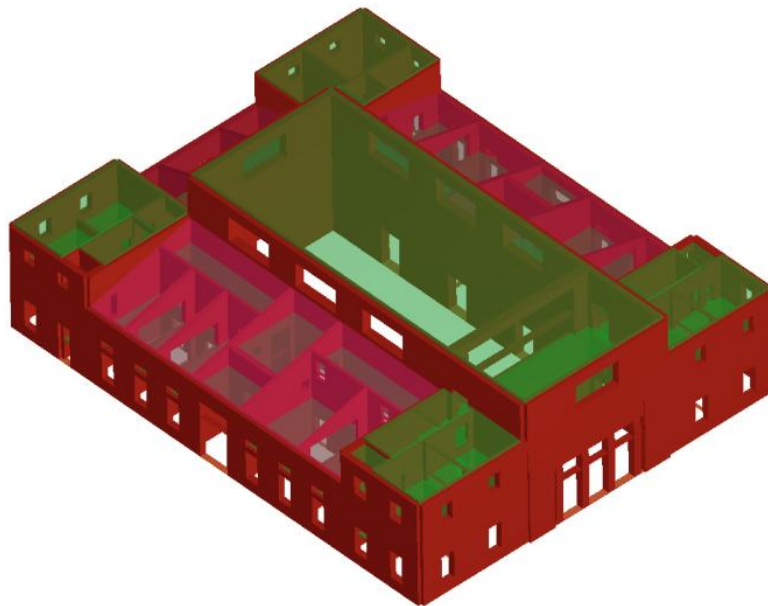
Vista tridimensionale – Prospetto ovest su via Beccaria e Prospetto nord su via Carmignani
